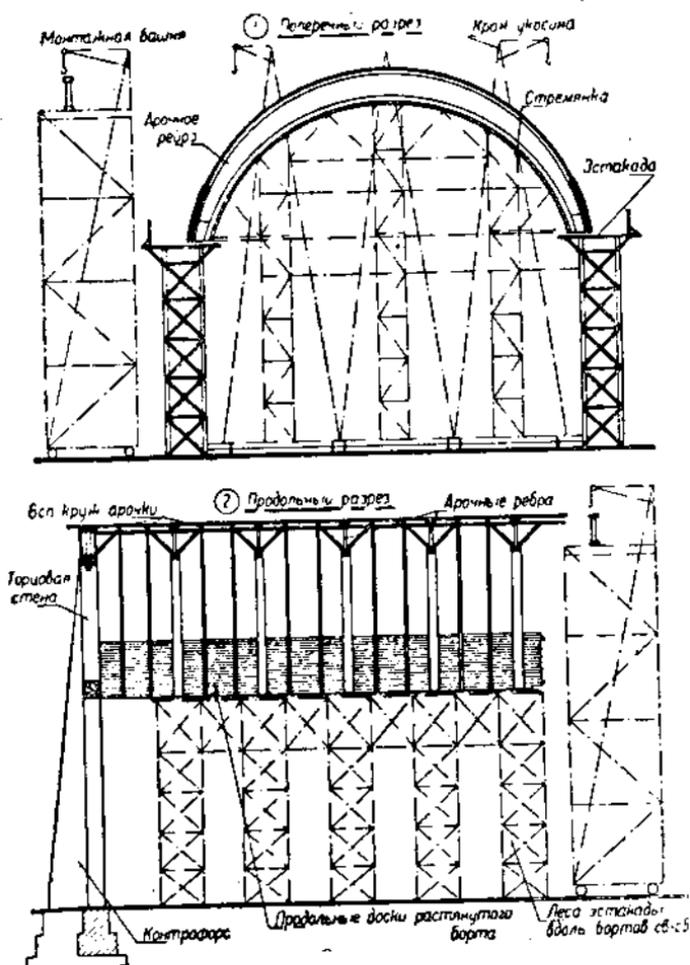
Ребристый свод-оболочка. Схема сборки: 1—поперечный разрез; 2—продольный разрез.
